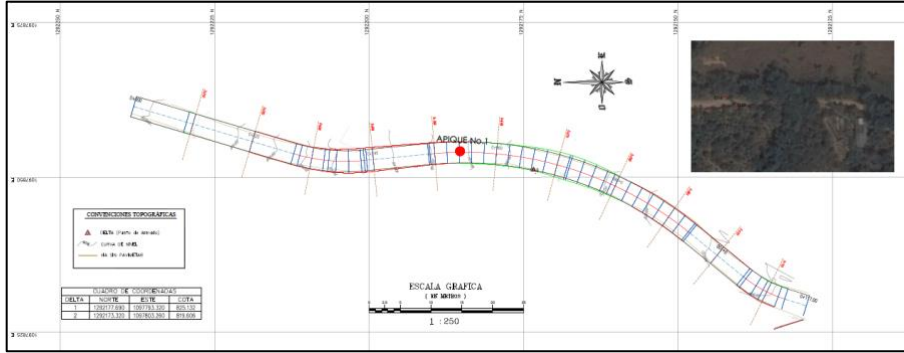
Imagen de planta del tramo 7 del proyecto de Rionegro-Santander
